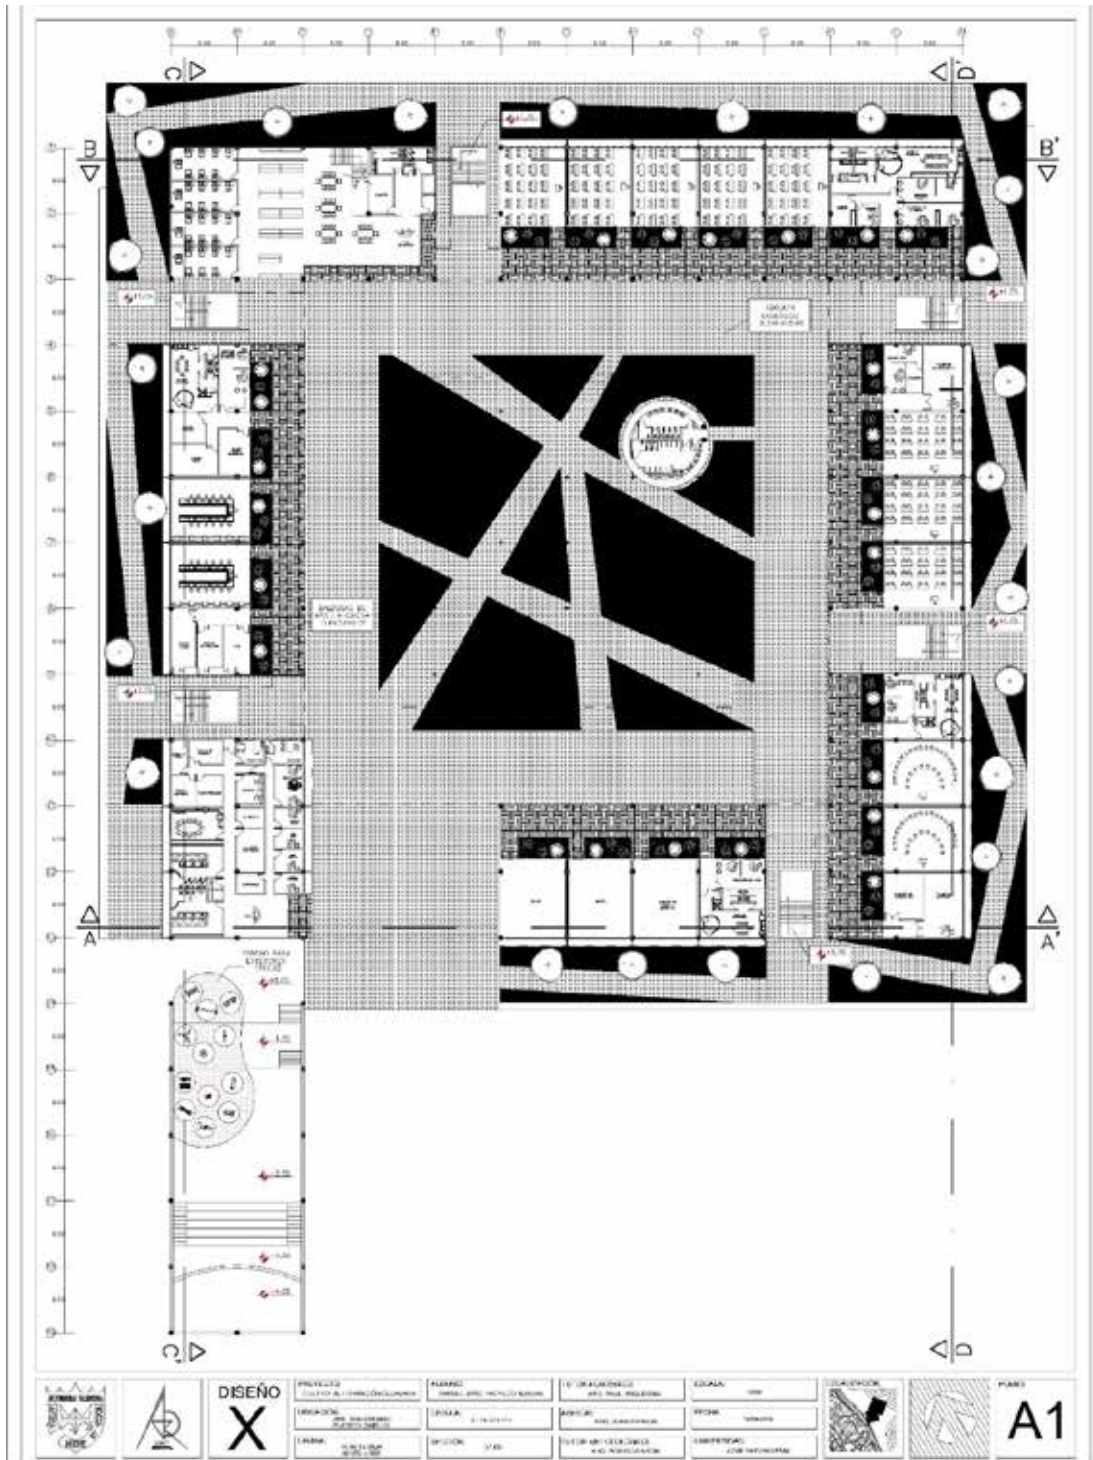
Planta Baja. Fuente: Propia autoría. (2018).
